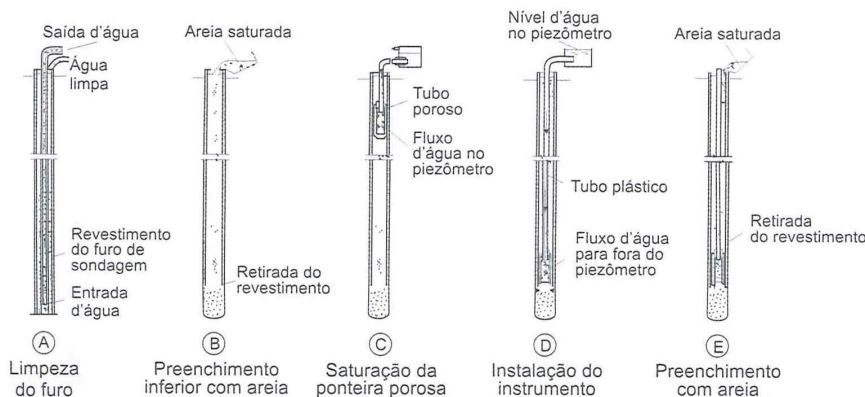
Etapas de instalação dos piezômetros até o preenchimento de areia saturada (modificado de Earth Manual, Bureau of Reclamation apud Silveira, J.F.A., 2006⁴)
